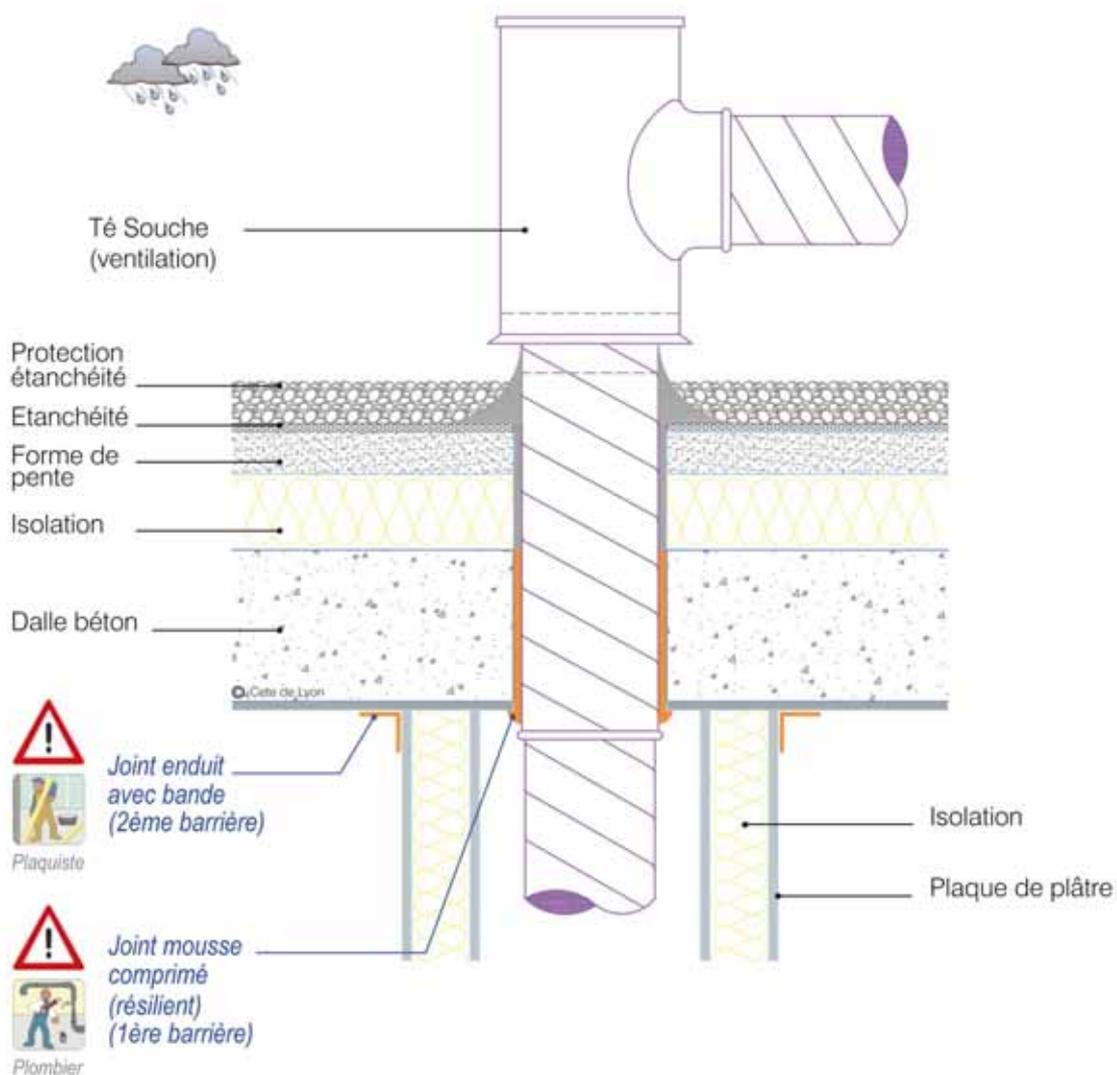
Traversée de gaines de ventilation en toiture terrasse
